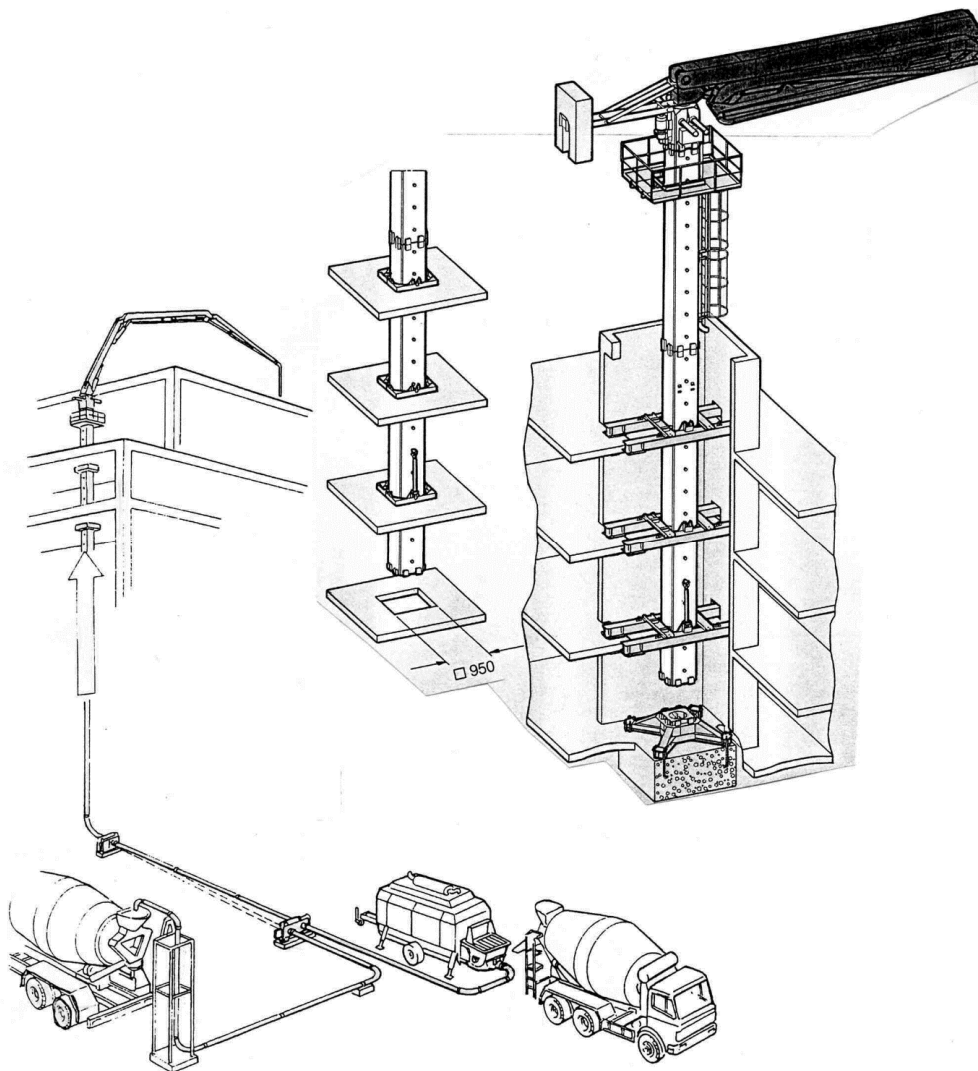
Подавання бетонної суміші причіпним бетононасосом з розподіленням самопідйомними маніпуляторами; схема очищення бетоновода від залишків бетонної суміші
